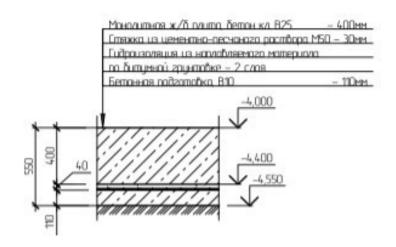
Деталь устройства бетонной подготовки под фундаментную плиту
